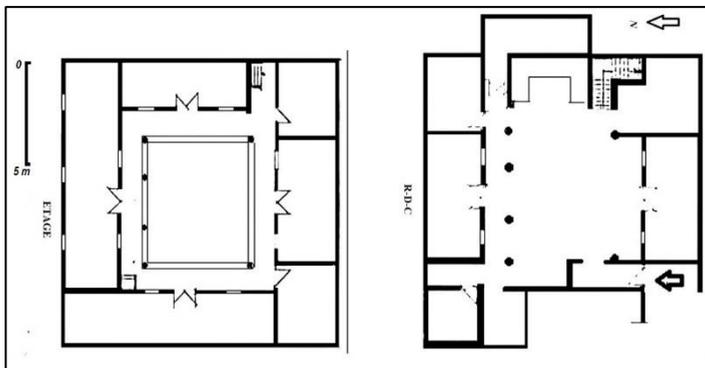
Planos de las plantas baja y alta de la casa de Ben Rayssūn¹¹
